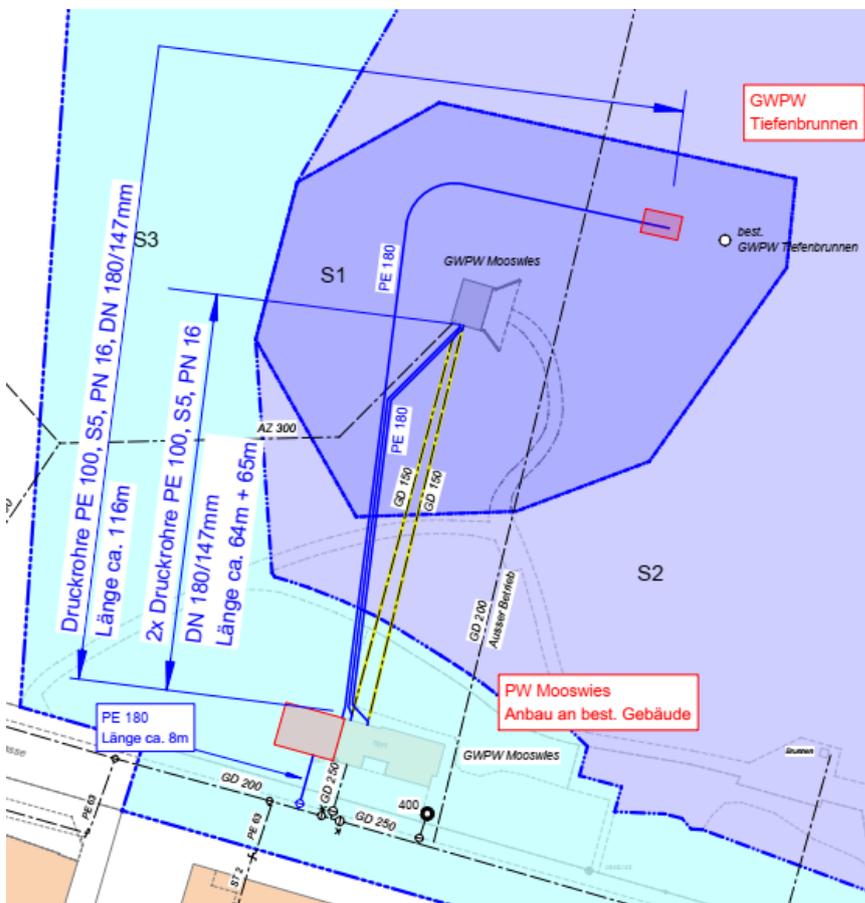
Grundwasserfassung Tiefenbrunnen mit Anbau an bestehendes Gebäude
